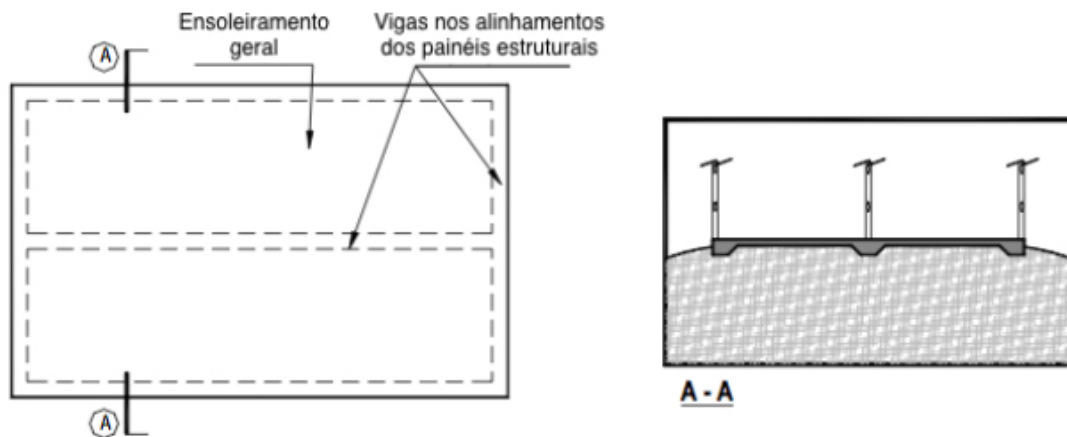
Planta e corte da solução com ensoleiramento geral.
